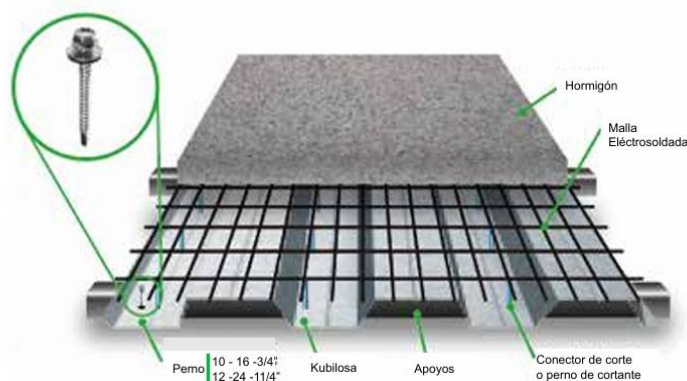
Componentes de losa colaborante (KUBIEC, 2024).
